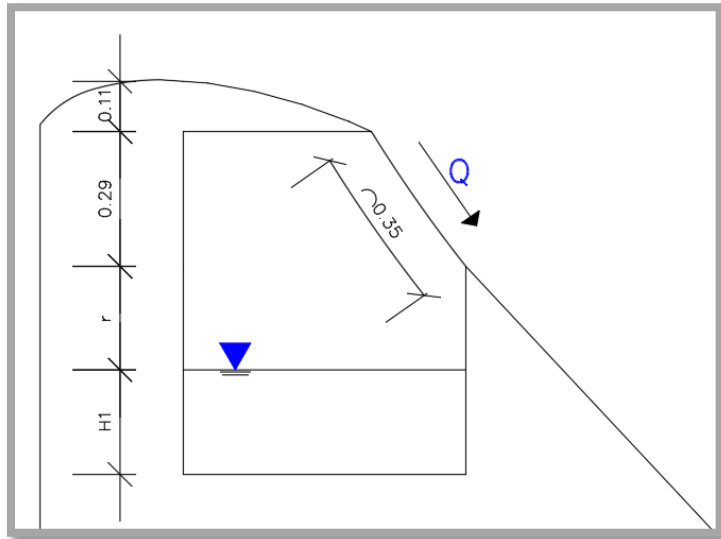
Vista de perfil de la Galería conociendo el ancho de la malla
